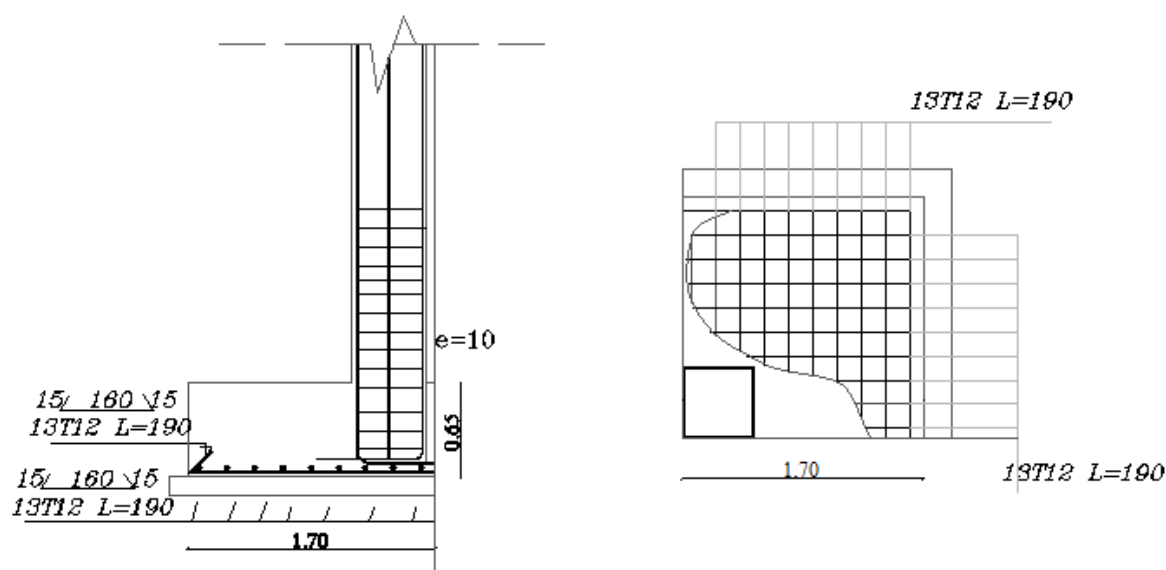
Schéma de ferrailage de semelle isolée de rive (y-y).
